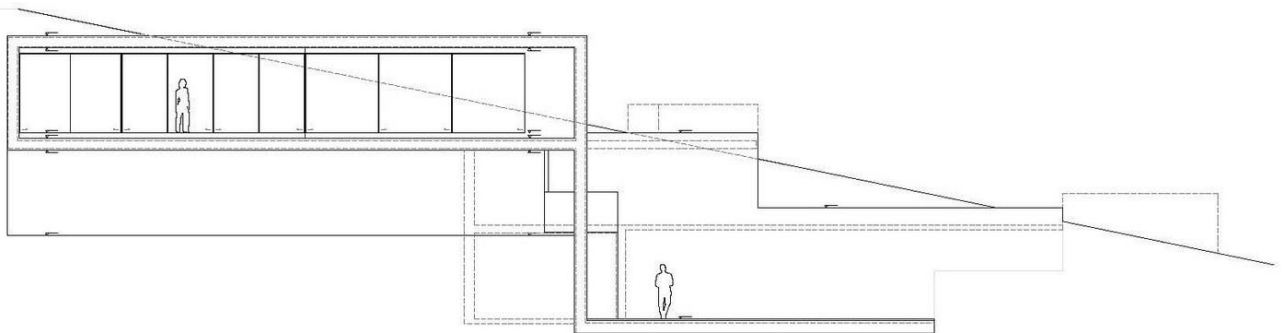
Alzado sureste. Fuente: Fran Silvestre Arquitectos.
